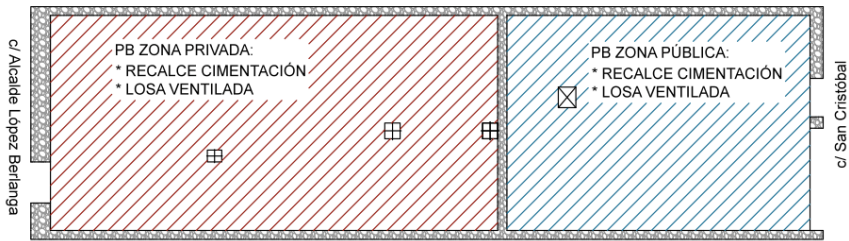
Zonas afectadas por la intervención en la cimentación. Fuente propia.
